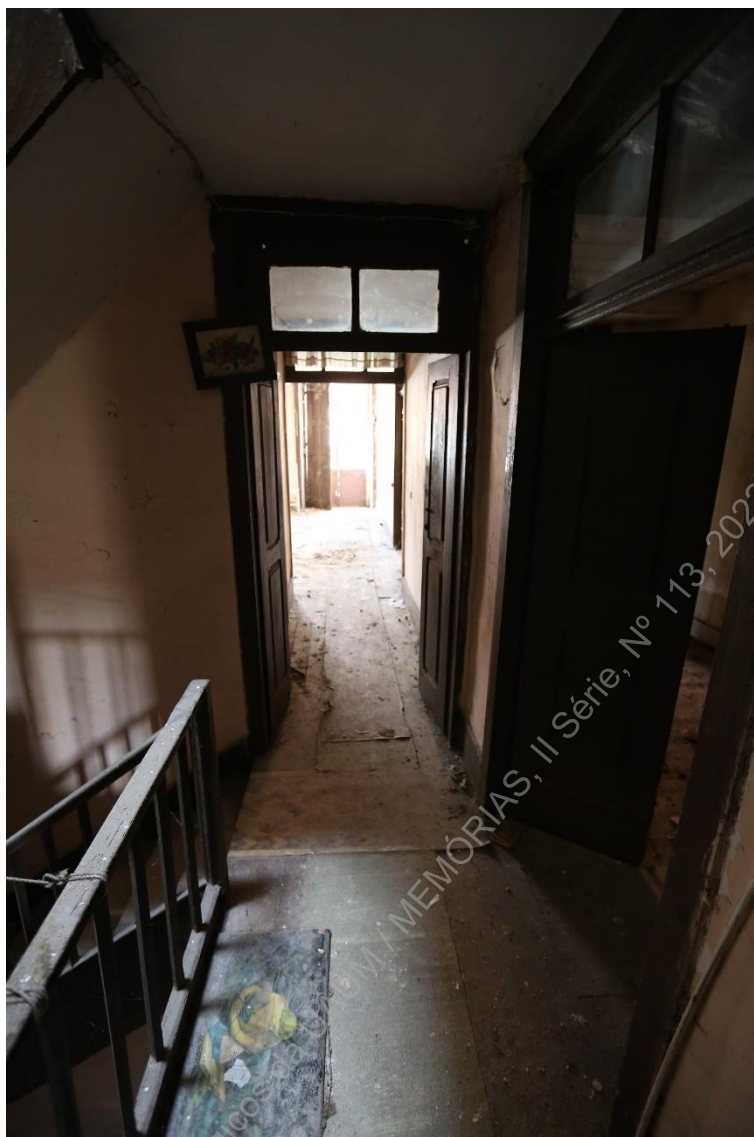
(Z45A4768) – Aspeto de corredor do primeiro piso.
